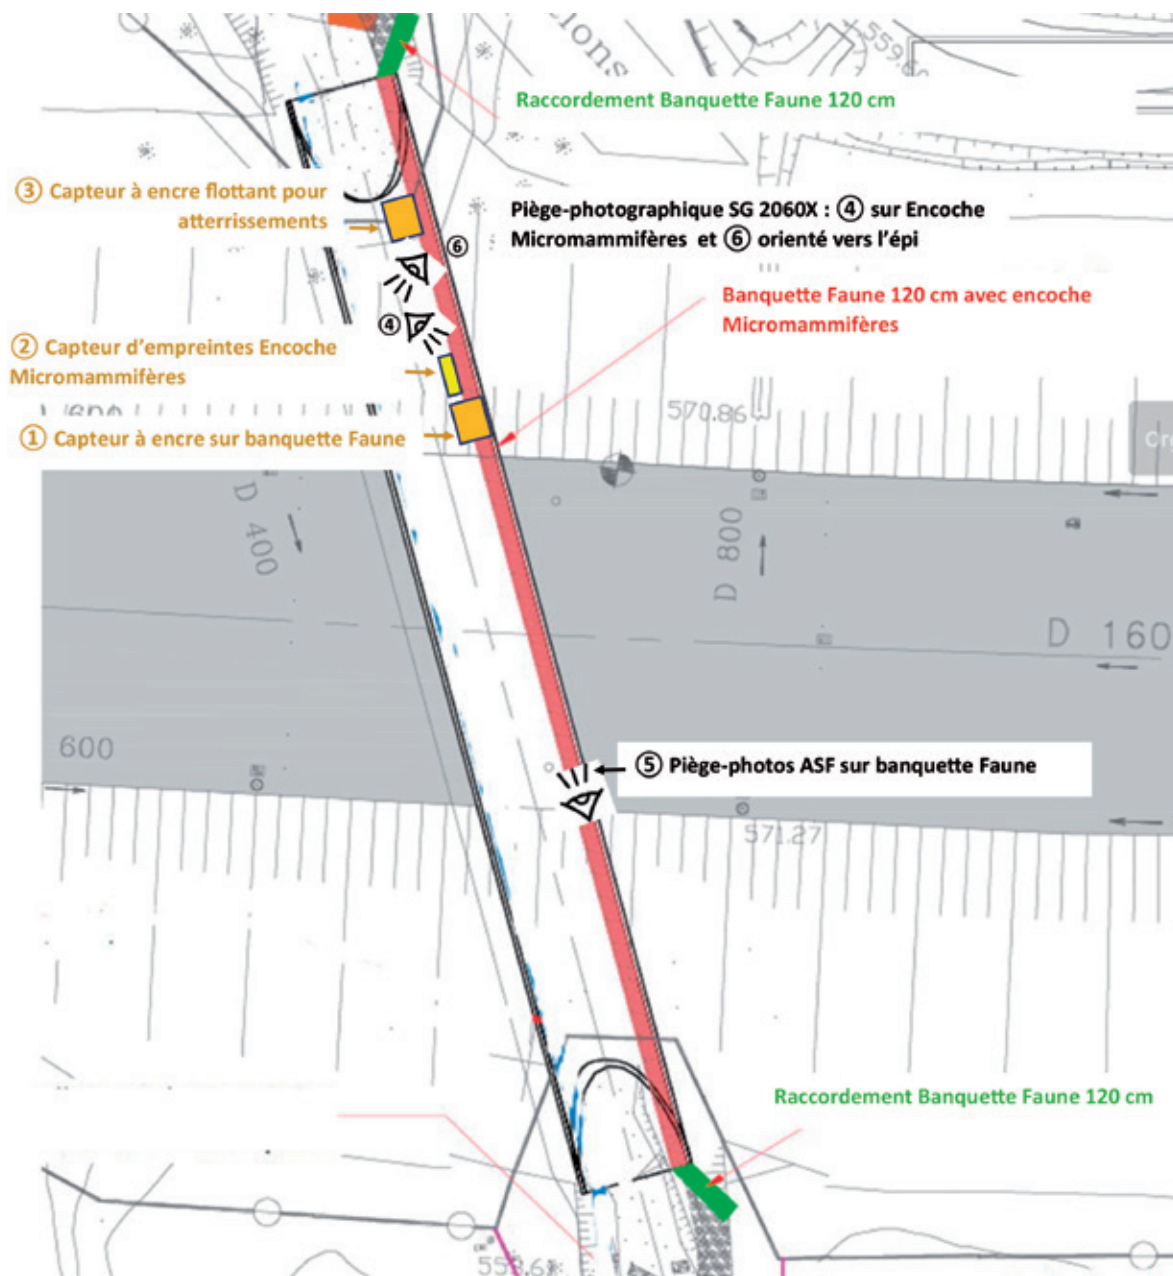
Représentation schématique des dispositifs de suivi sur les plans d'ouvrage du Deiro
